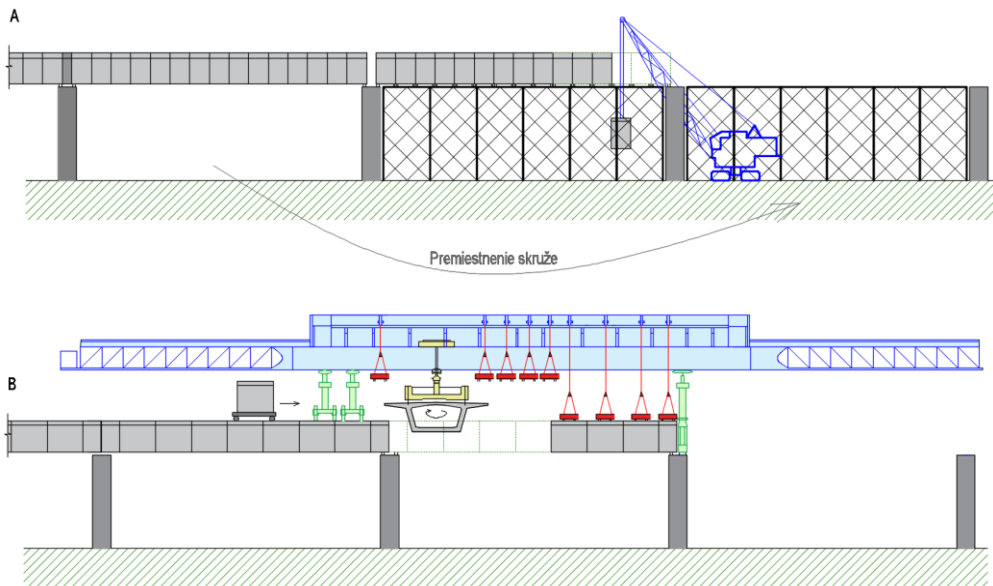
Letmá montáž vyvesovaním segmentov (ScS)
